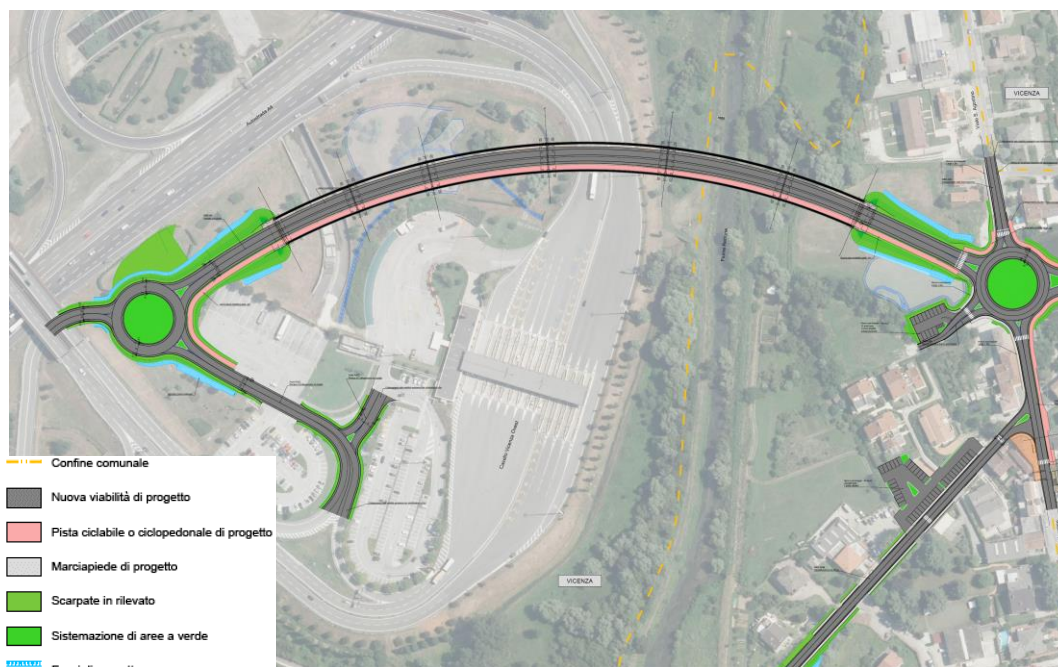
Planimetria della nuova viabilità Casello VI Ovest e Ponte sul Retrone
